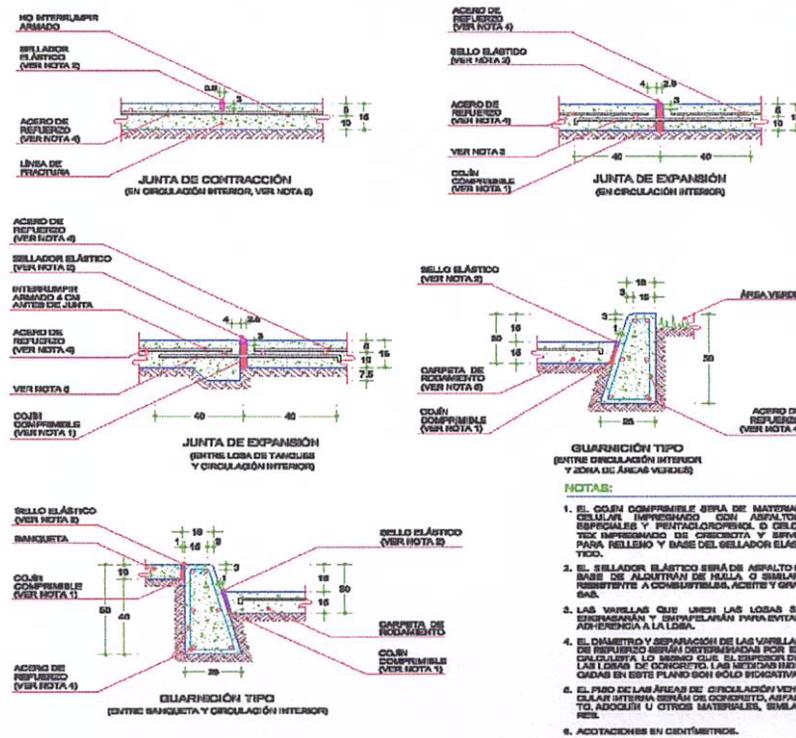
Juntas de contracción y expansión en zona de tanques y circulación terrestre.
